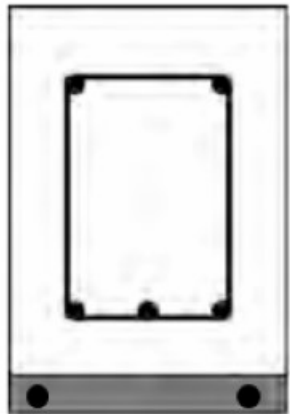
Расчетная схема поперечного сечения изгибаемого железобетонного элемента при усилении сталефибробетонной рубашкой для построения нелинейной деформированной модели
